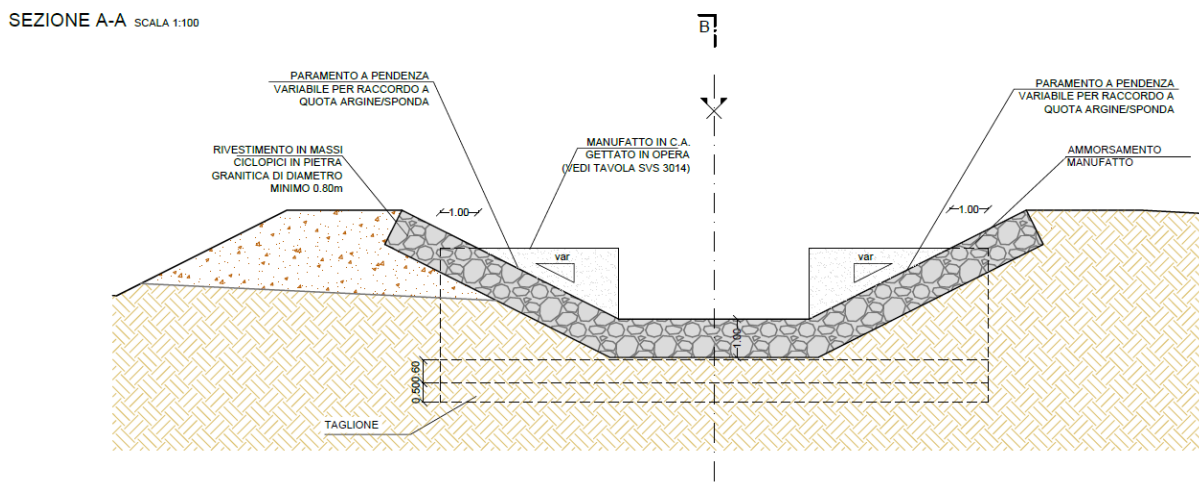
Sezione tipo longitudinale tipo del manufatto di restringimento delle aree golenali
